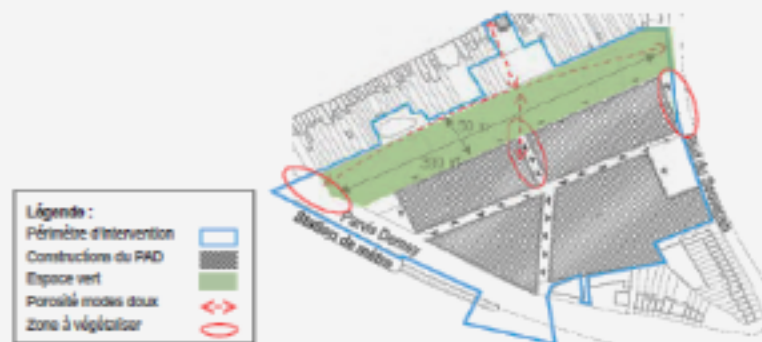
Aménagement en plan du parc urbain Demey (ARIES sur fond ORG³, 2018)
